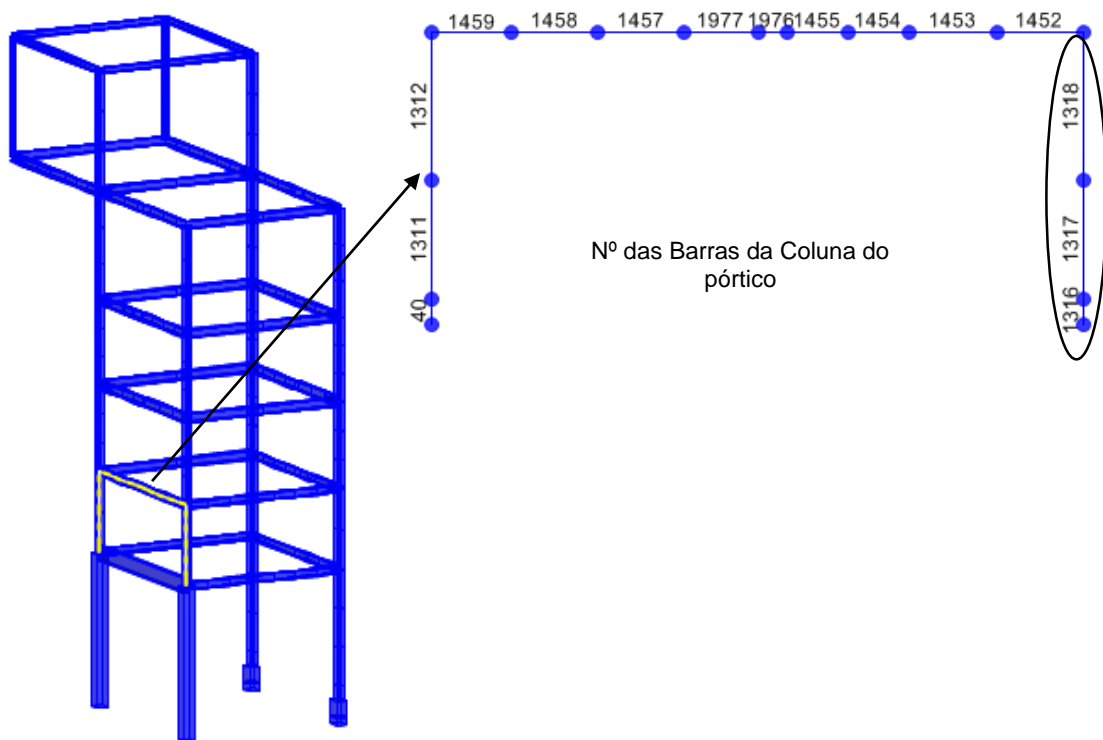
Identificação das Barras da Coluna do Pórtico.
